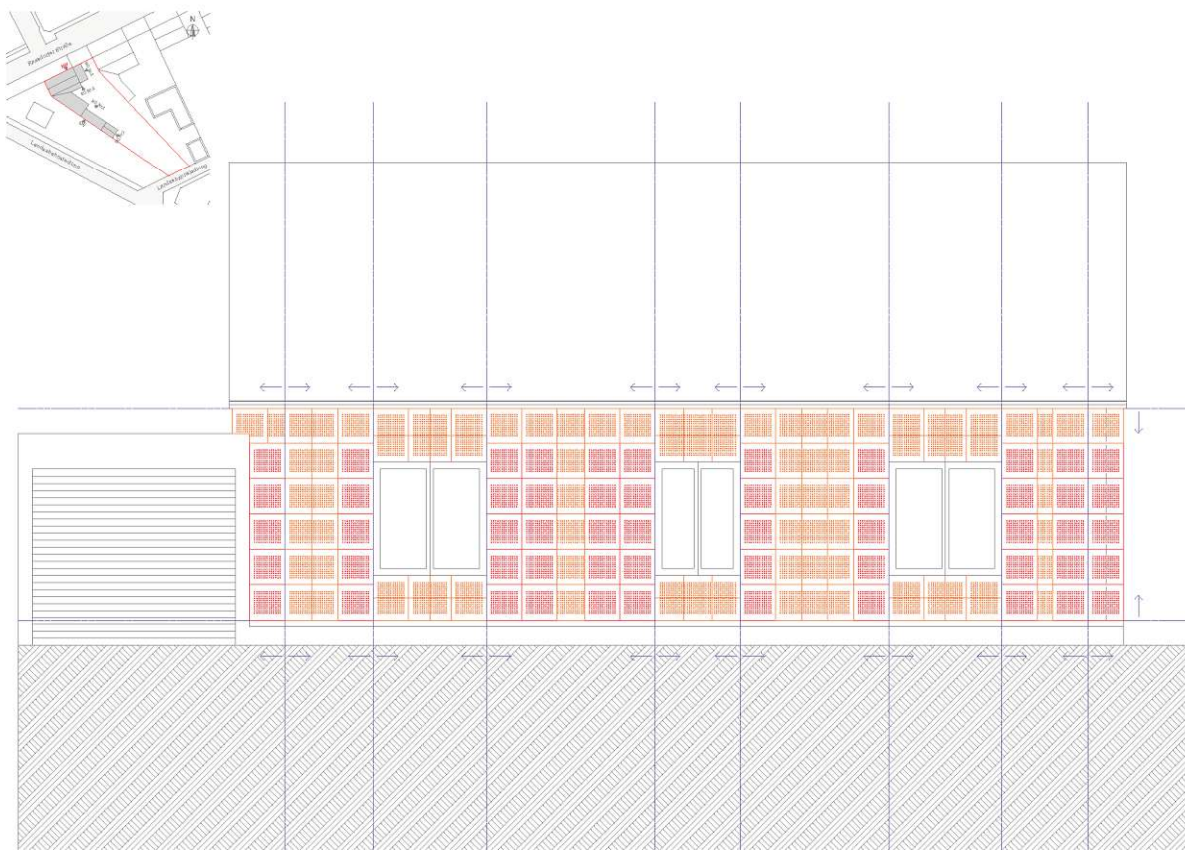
Grundmodulanwendung an der Nordwestfassade
